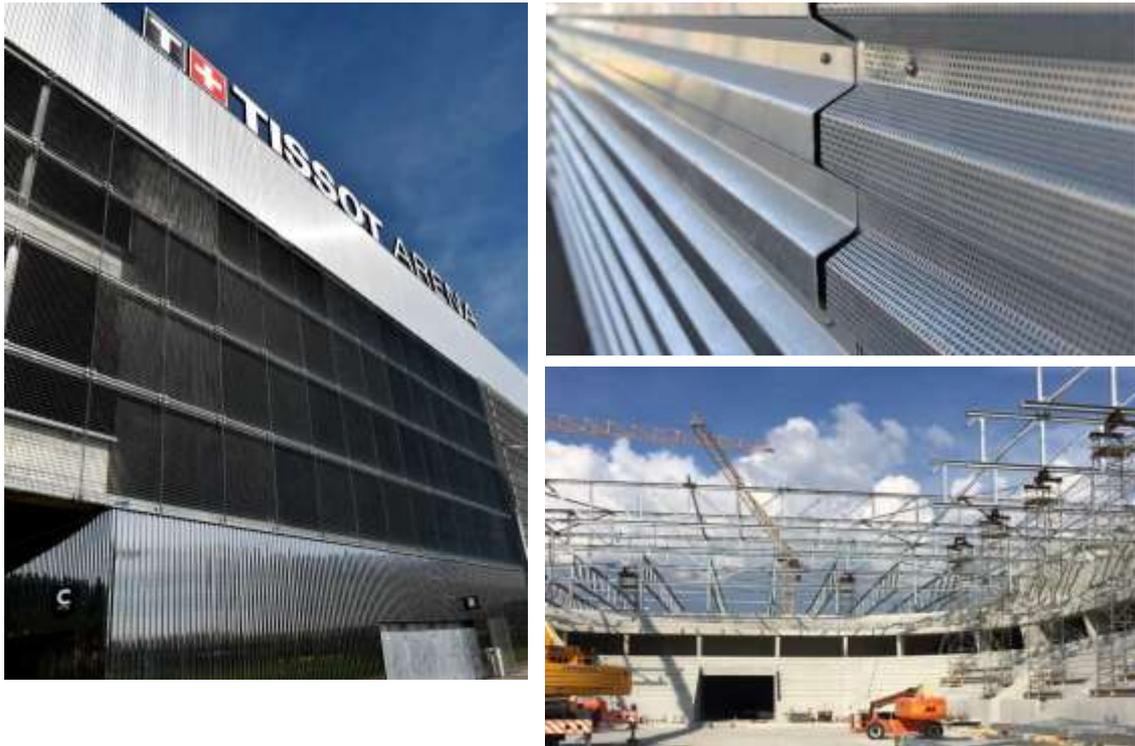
Les matériaux de construction : Béton, Acier, inox et aluminium
